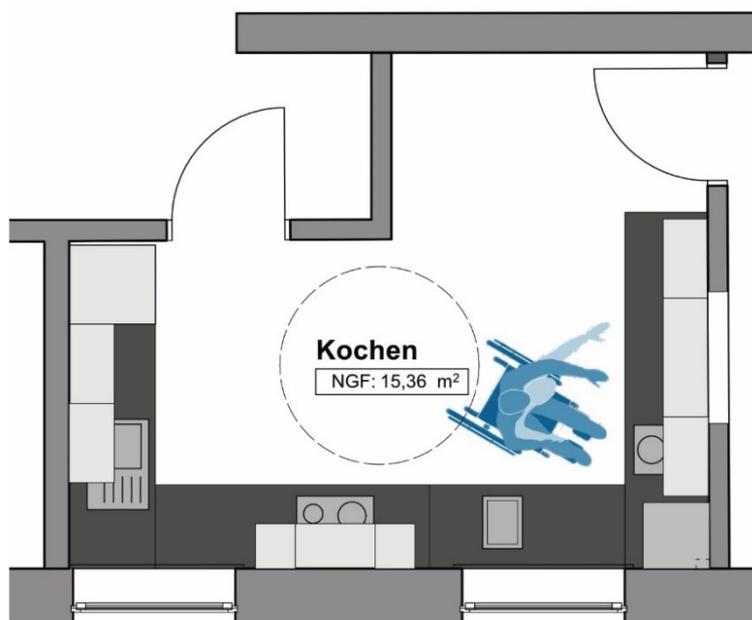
Entwurfsplanung Grundriss grüne Küche mit Erweiterung
